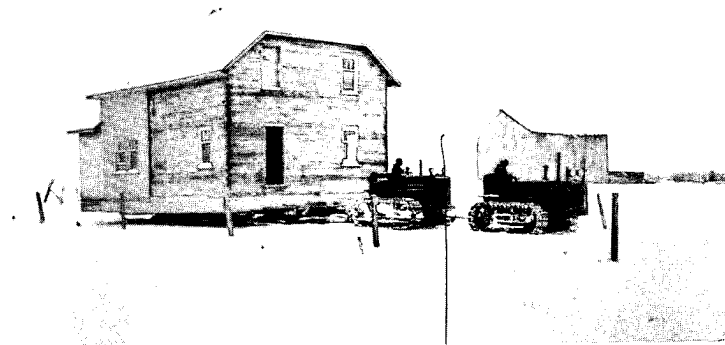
Un colon fait déménager sa maison de la campagne au village (Photo de M. Simon Filion).
